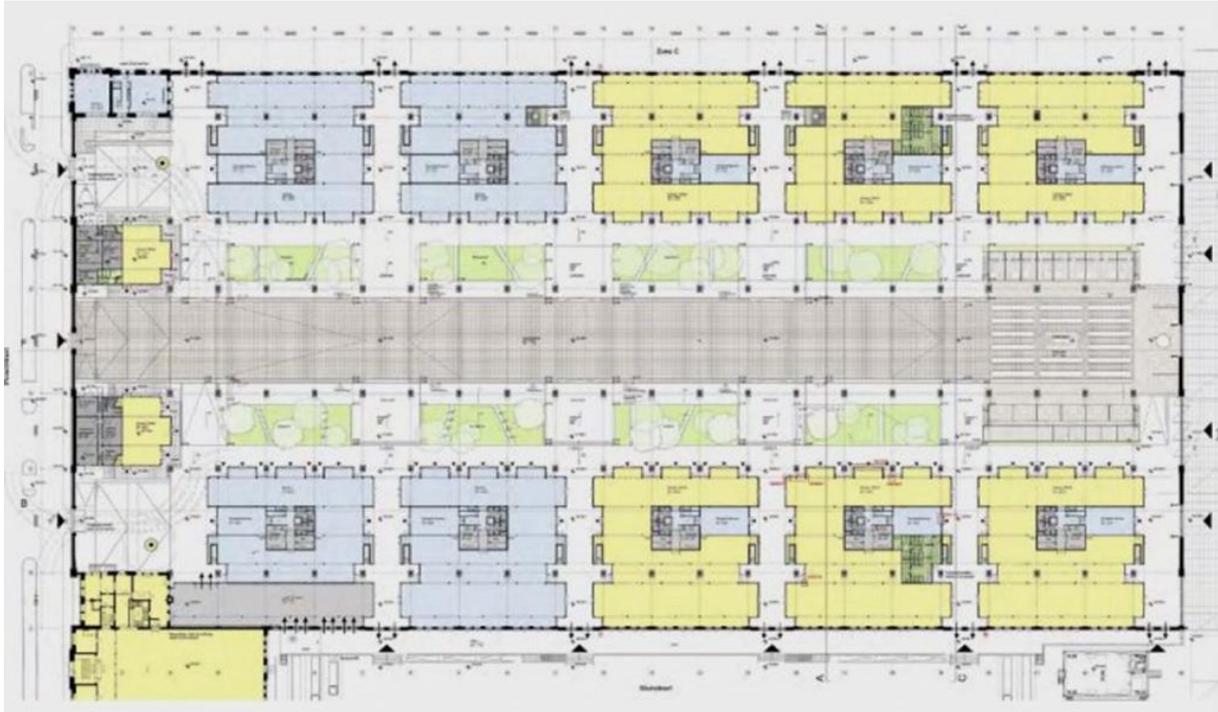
10 Blöcke und 2 Kopfbauten im Grundriss (Quelle: Extensa)
